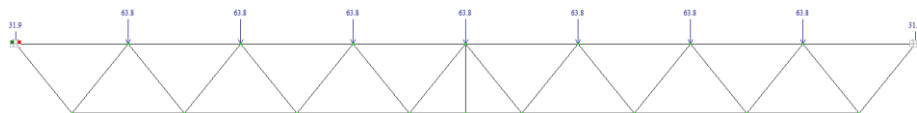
«Расчетная схема стропильной фермы» [11]
